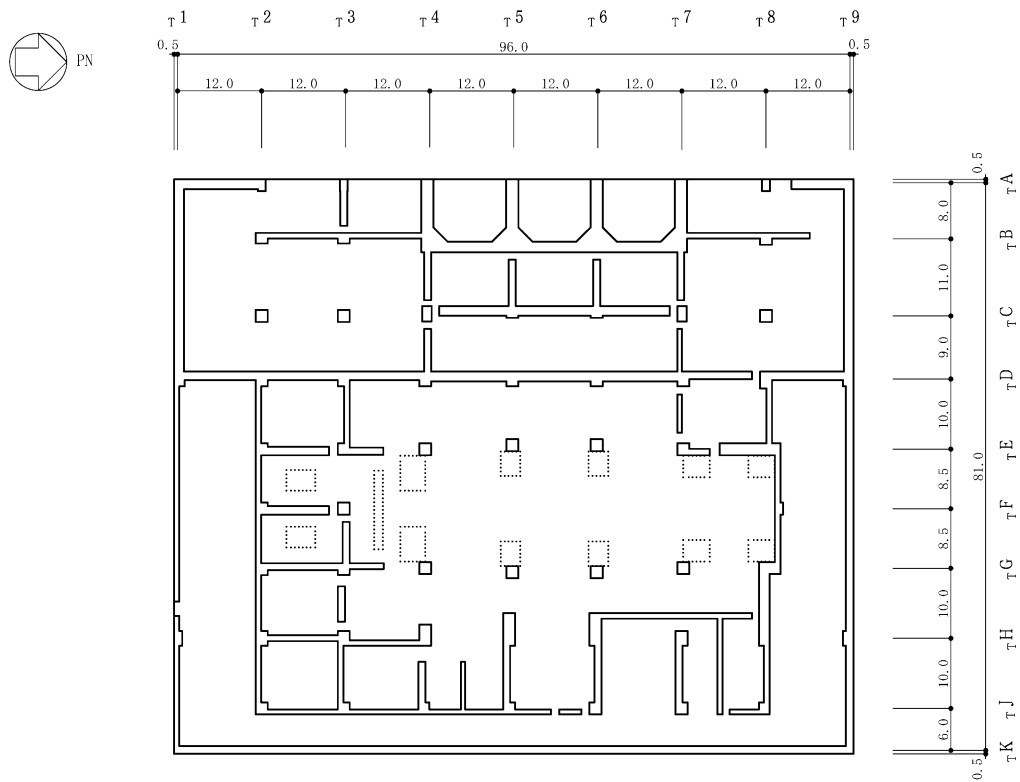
タービン建屋の概略平面図 (B2F, T. M. S. L. -5. 1m) (1/6) (単位 : m)
